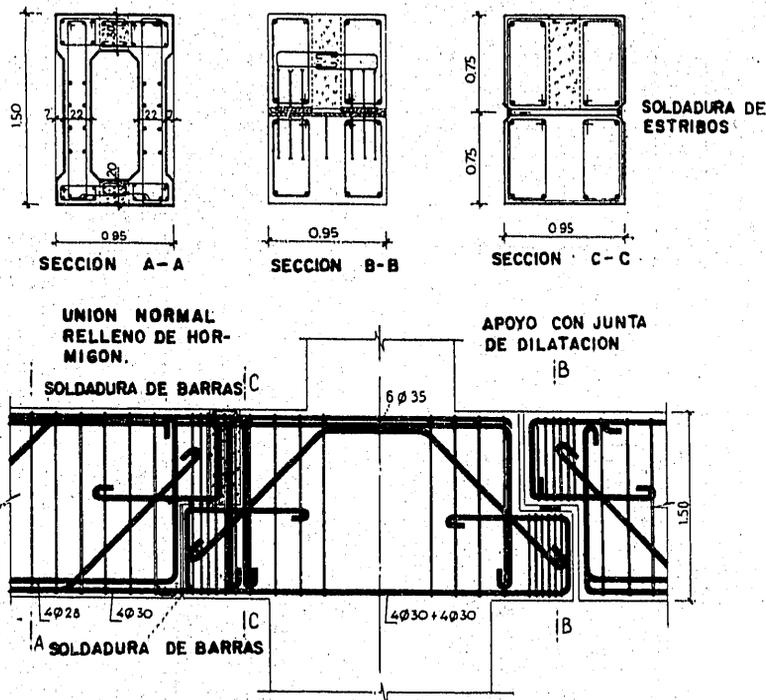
^a - Detalle de las armaduras para unión de continuidad y para junta de dilatación.
